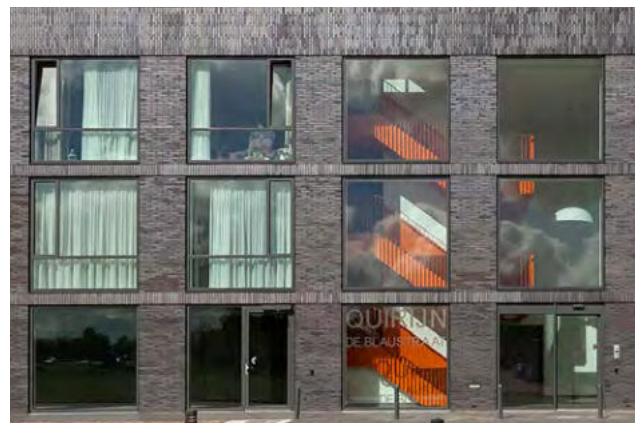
Regelmässige Fassaden überspielen Treppenhäuser. Diese sind wie große Zimmer im Gebäude zu behandeln.
